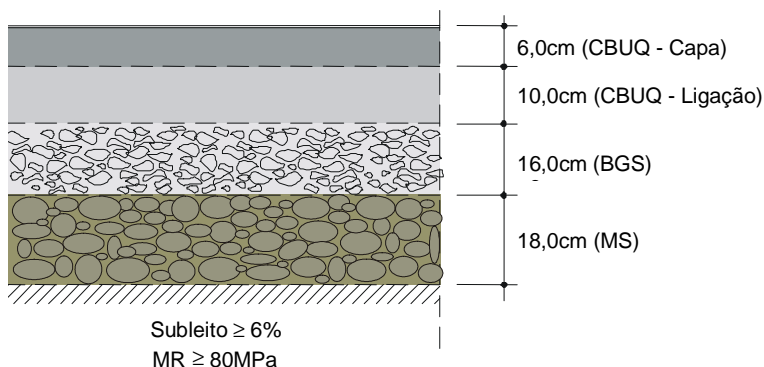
Estrutura de pavimento – Baia de estacionamento
